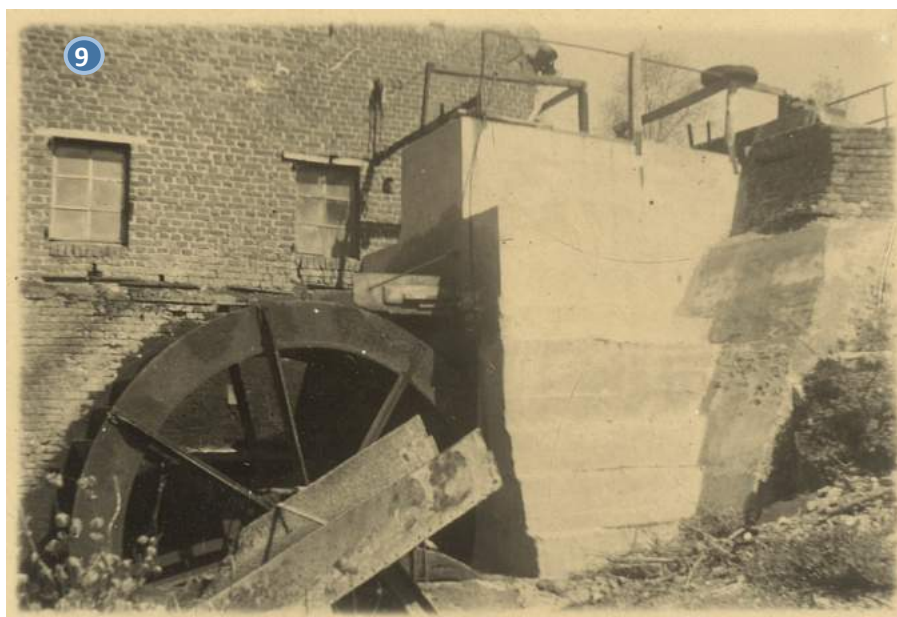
zicht op de nieuwe betonnen maalgoot en het watterrad (begin jaren '40)
